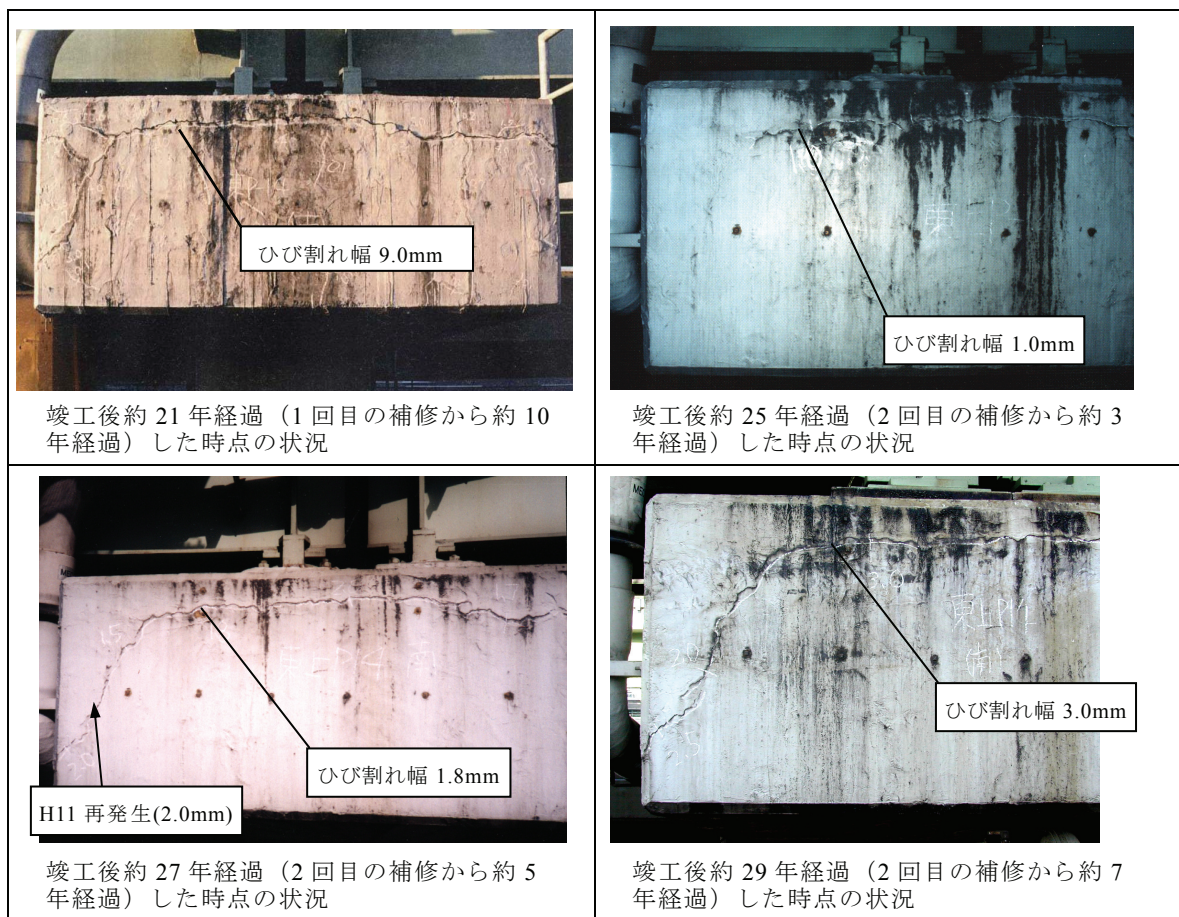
梁端部におけるひび割れ発生状況
